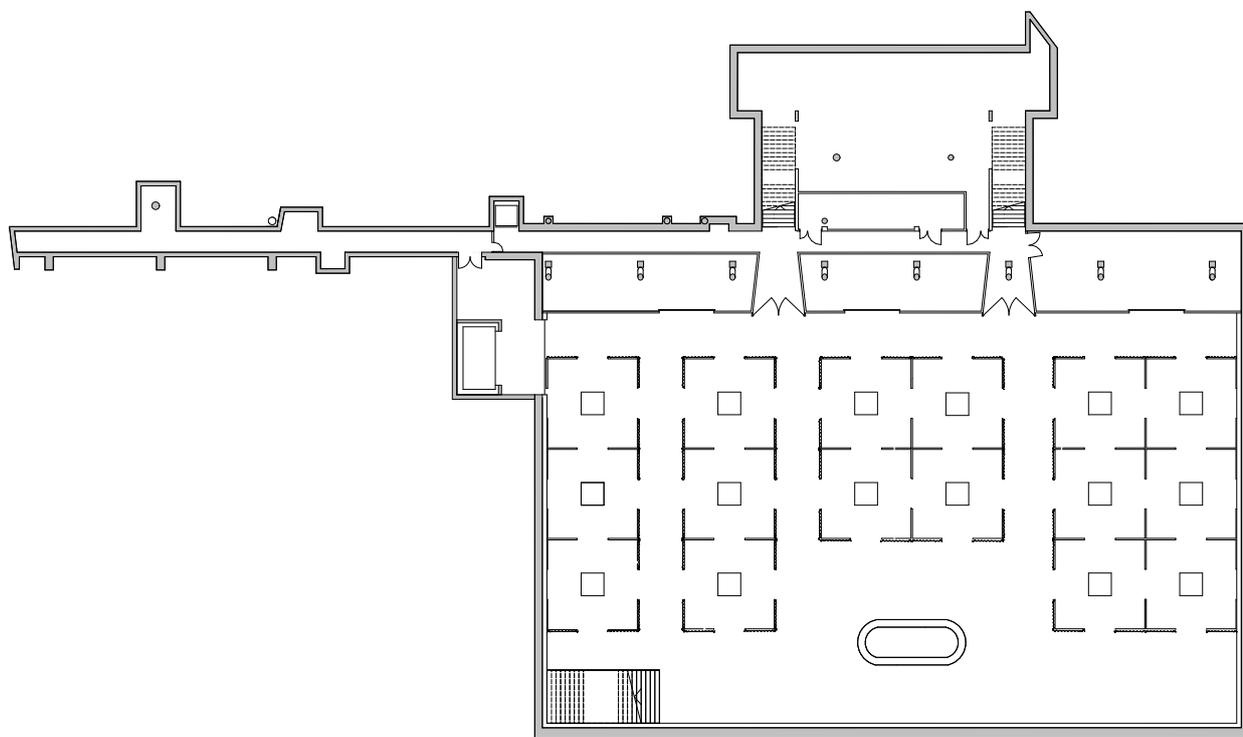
Grundriss 2.UG - Messe | Markt
